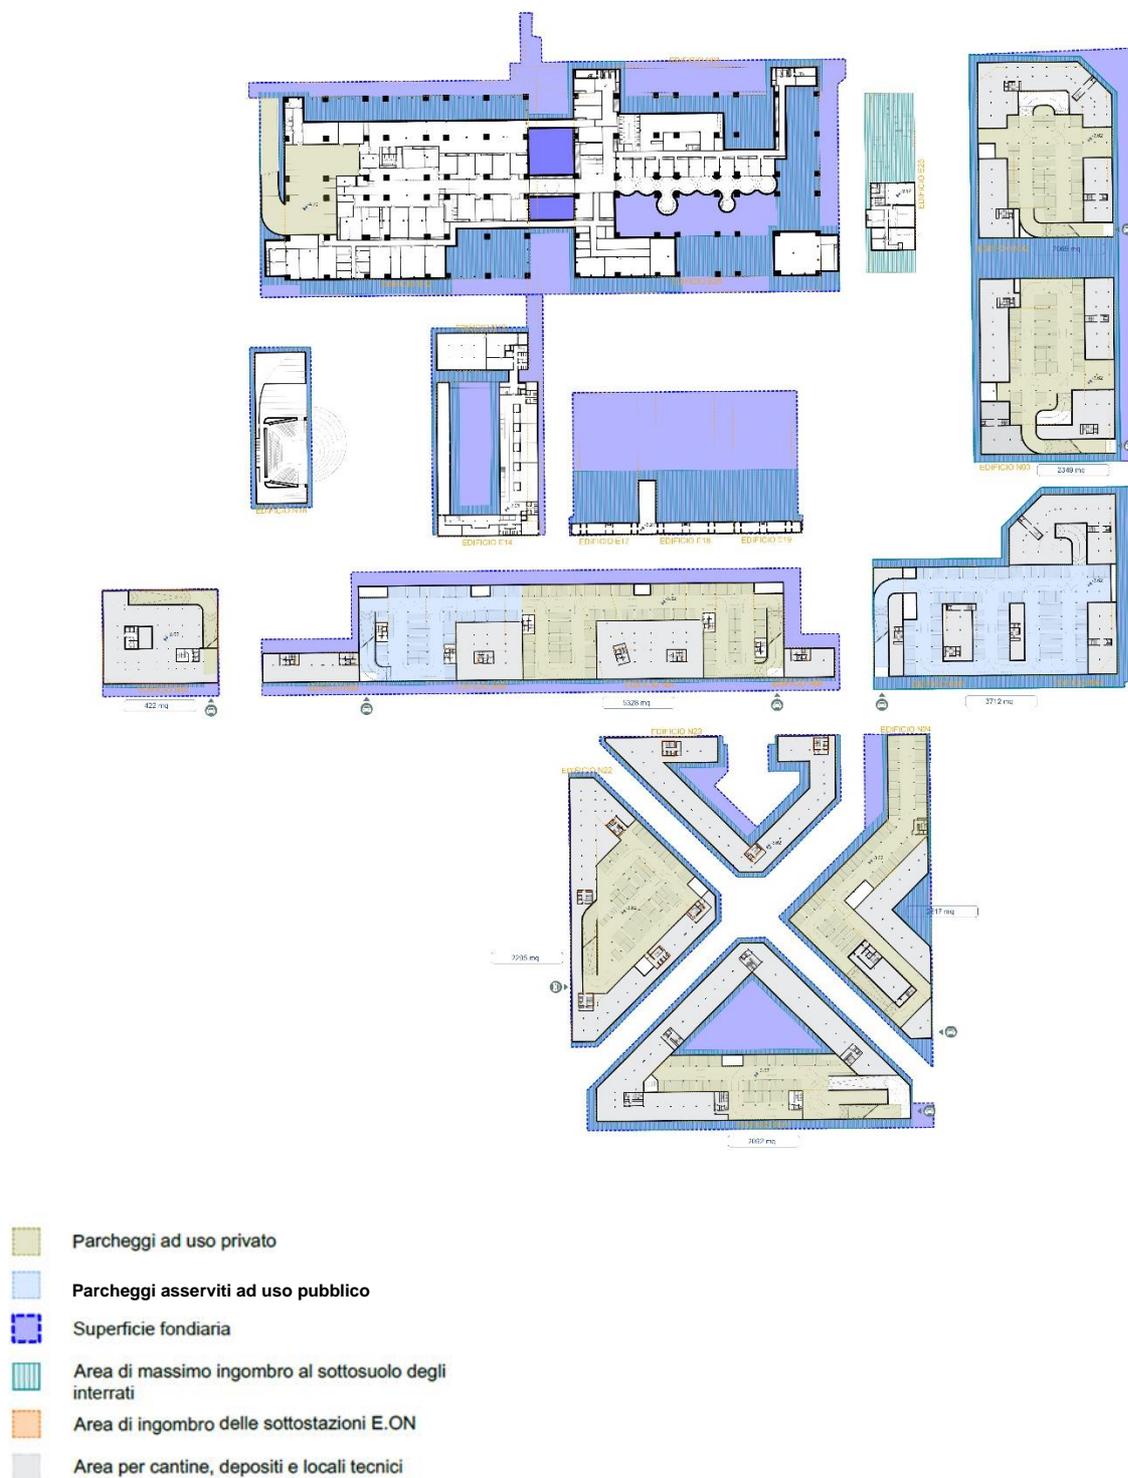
27. Planimetria piano primo interrato - Parcheggi privati e asserviti al pubblico
